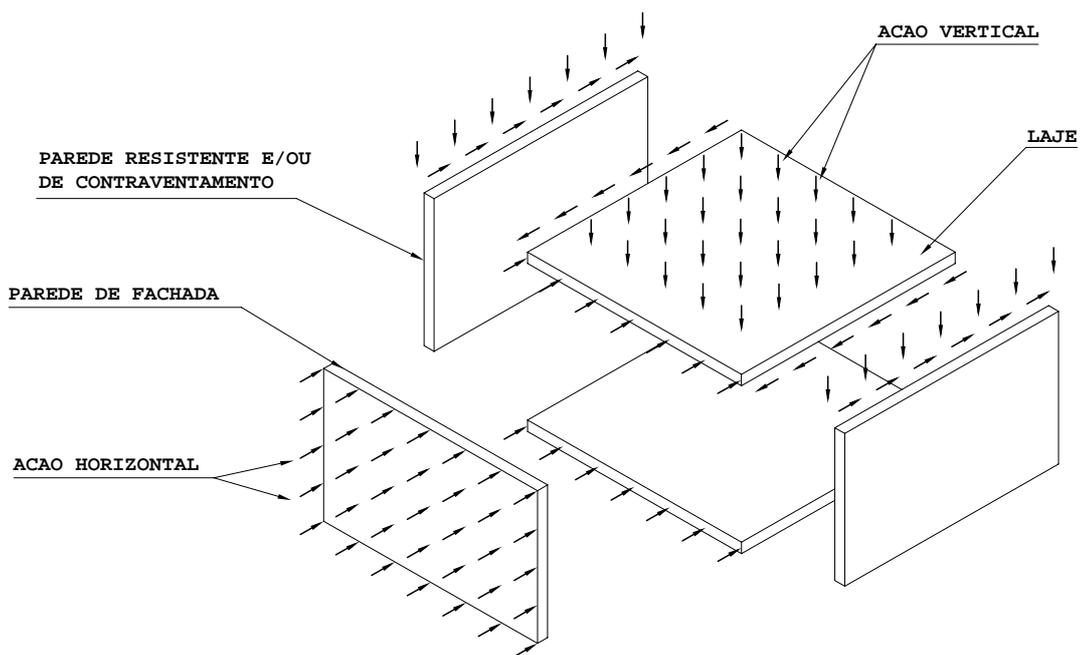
Ações atuantes em um sistema estrutural tipo caixa.
